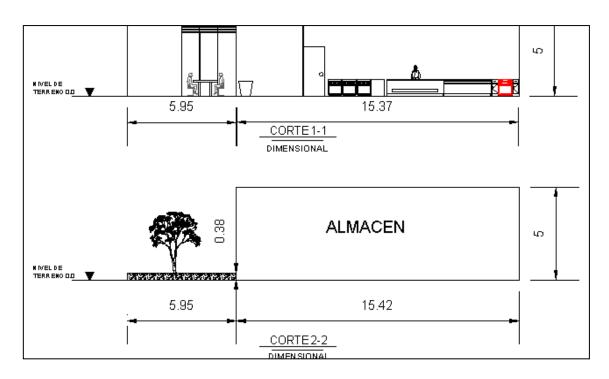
Corte 1-1 y corte 2-2 de la zona de estudio para la planta de biogás
